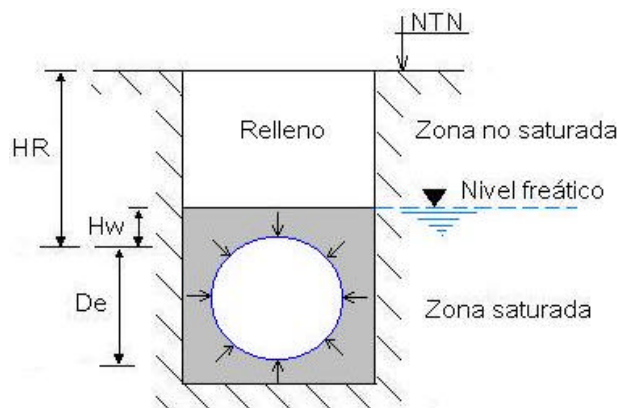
Tubo enterrado bajo la acción de agua subterránea
